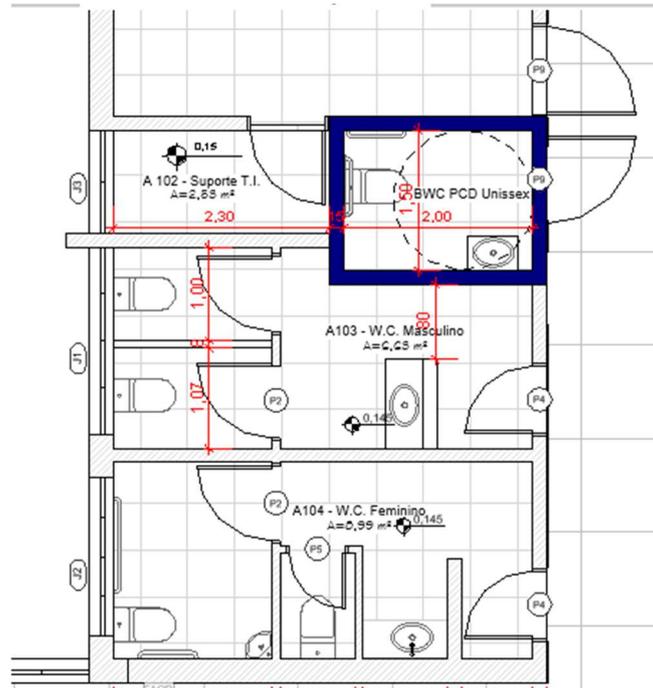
Proposta sanitário Acessível pavimento térreo.
